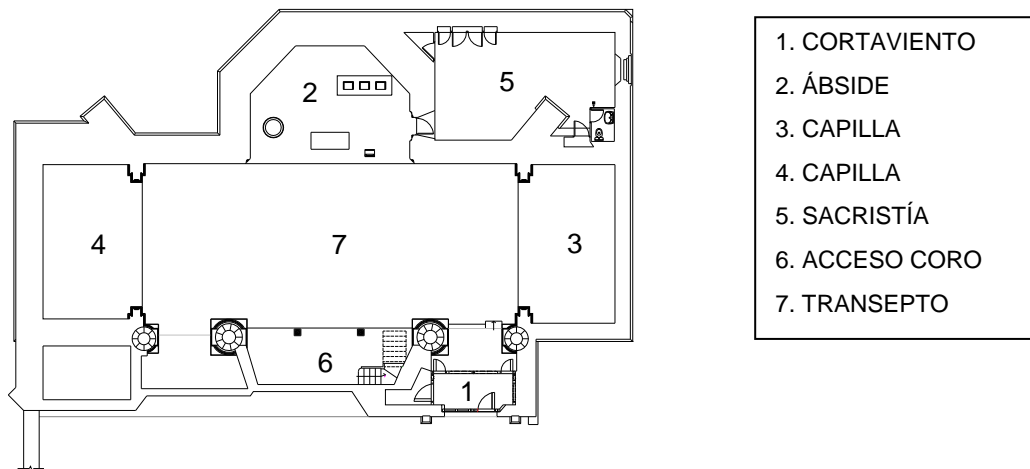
Plano en planta del estado actual de la Iglesia Nuestra Señora de la Asunción.
